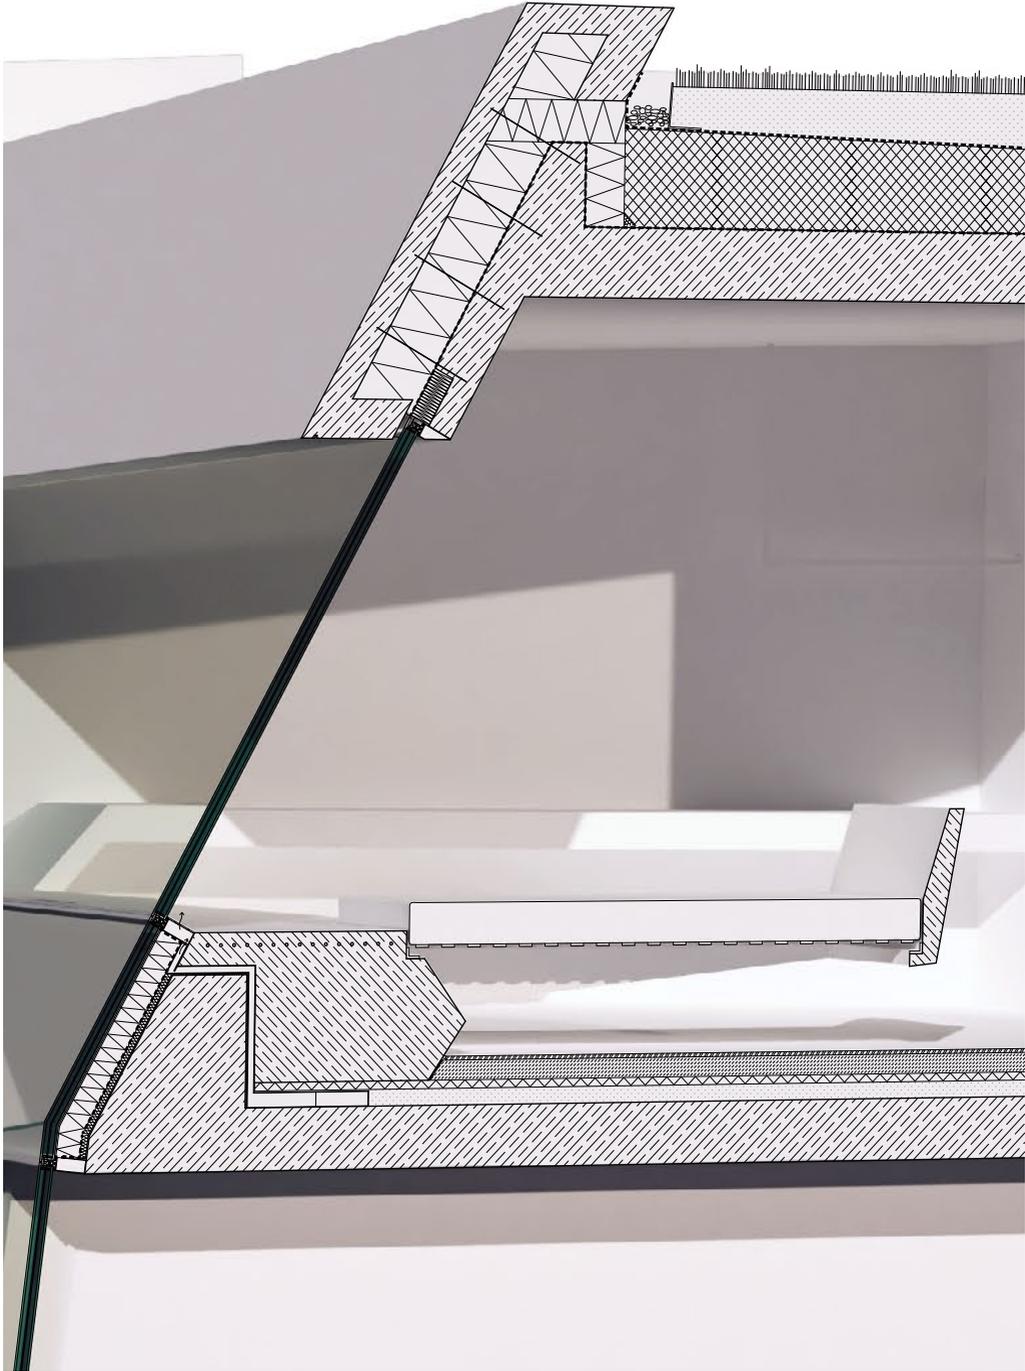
| Detailfassadenschnitt Ebene -3,5m
